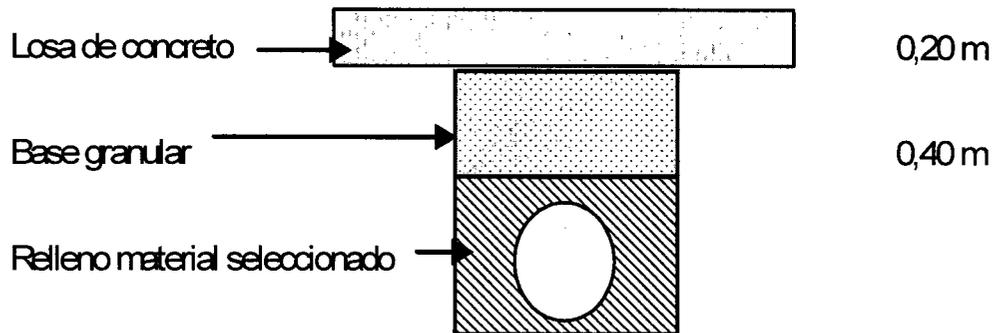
Estructura tipo en Pavimento Rígido para intervenciones en zanja sobre vías locales.
